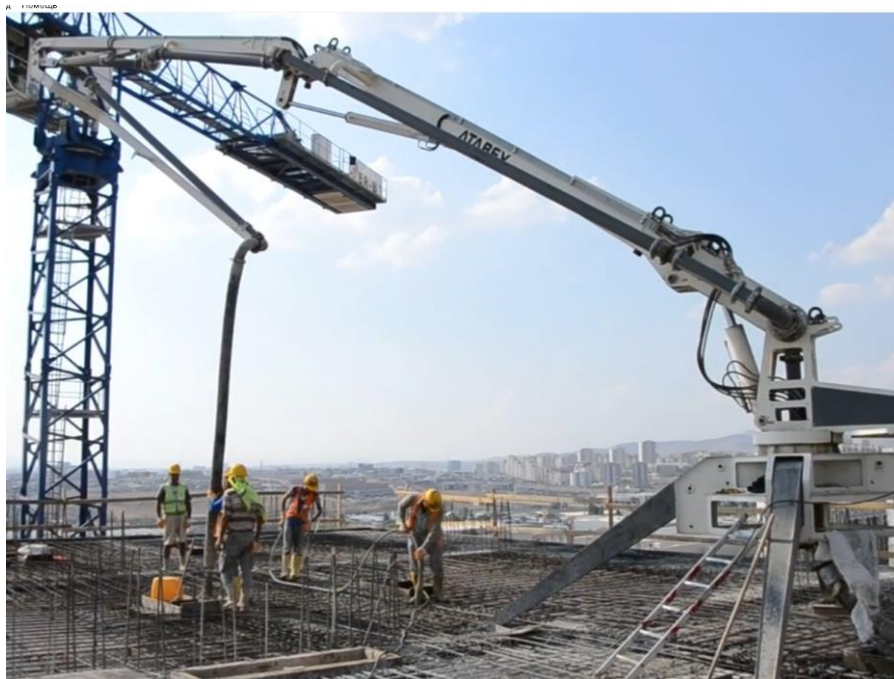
Укладка бетонной смеси с помощью распределительной стрелы при устройстве монолитного перекрытия здания
